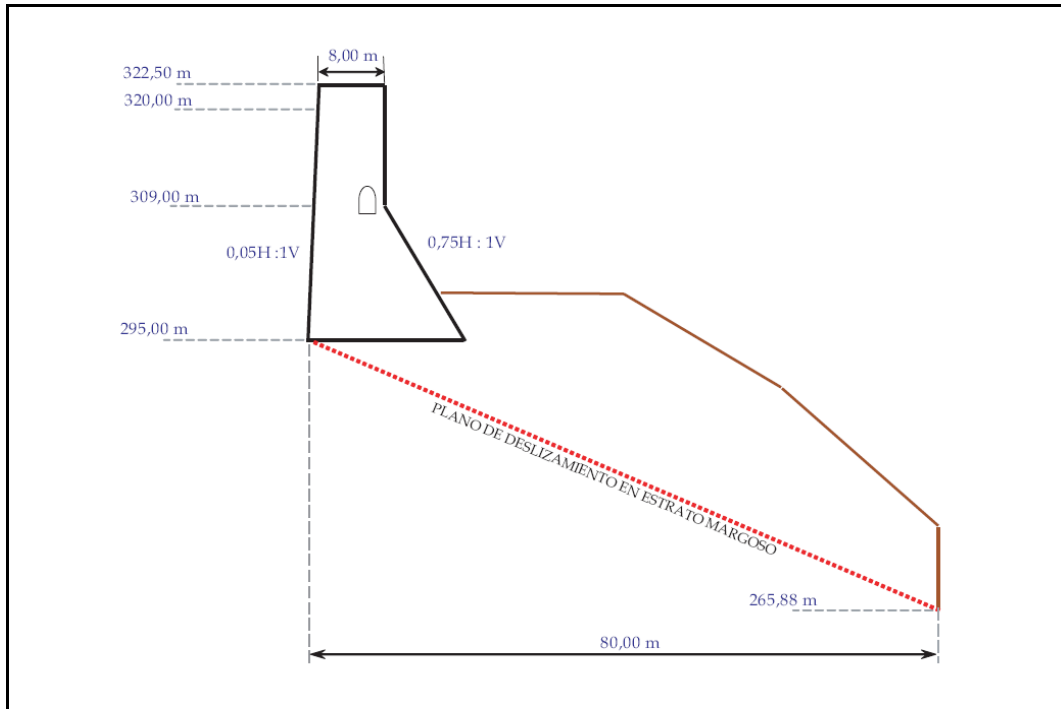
Sección transversal de la presa en las proximidades del estribo derecho (fuente: Membrillera [92]).
